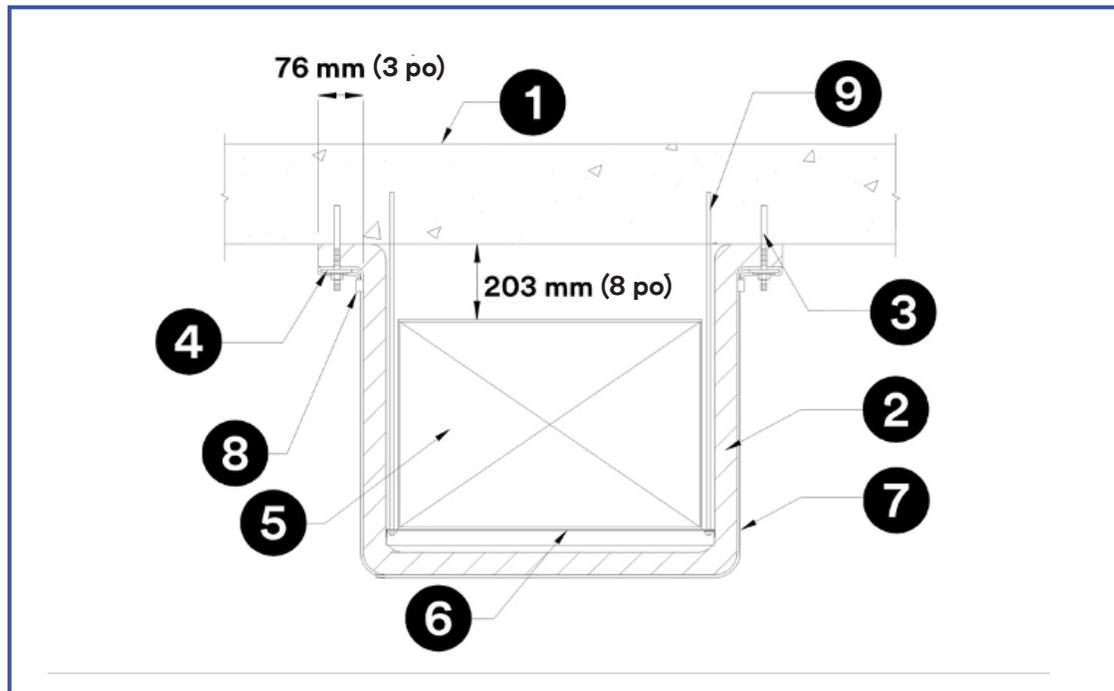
b – Installation suggérée sur un conduit de ventilation à trois côtés
